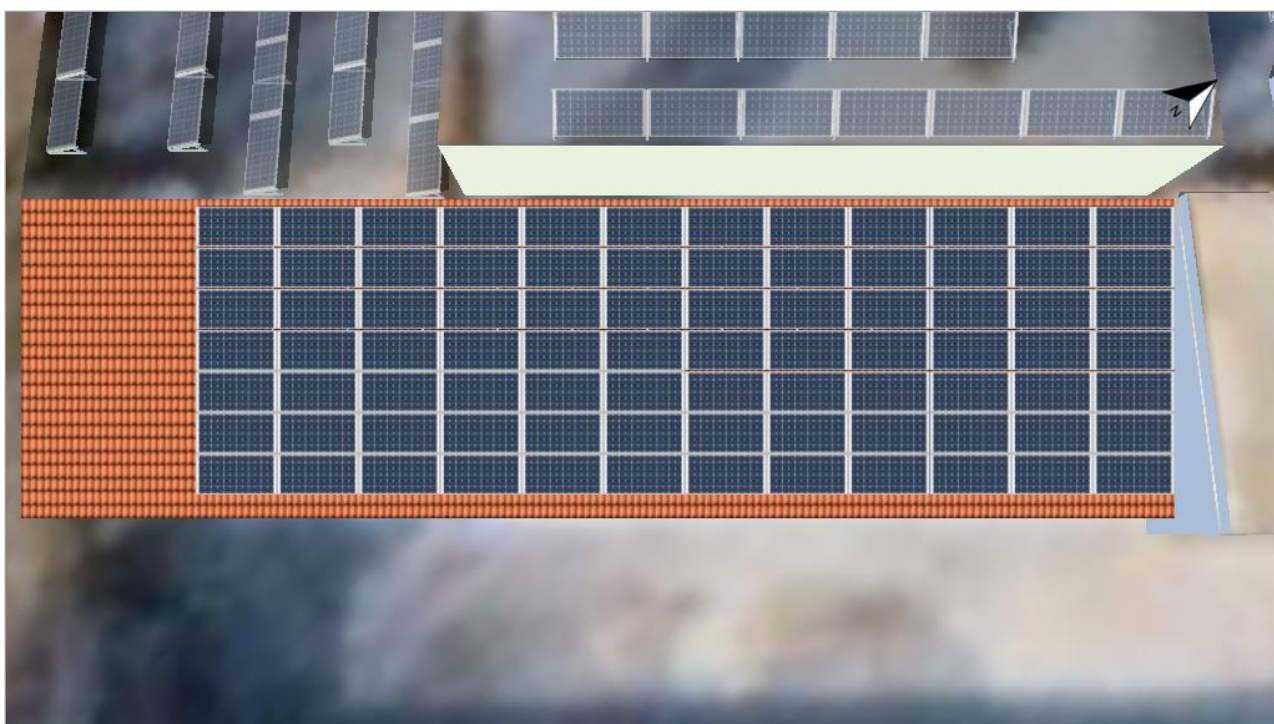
Zona modulului - Projecting Roof 01-Mounting Surface Southeast
